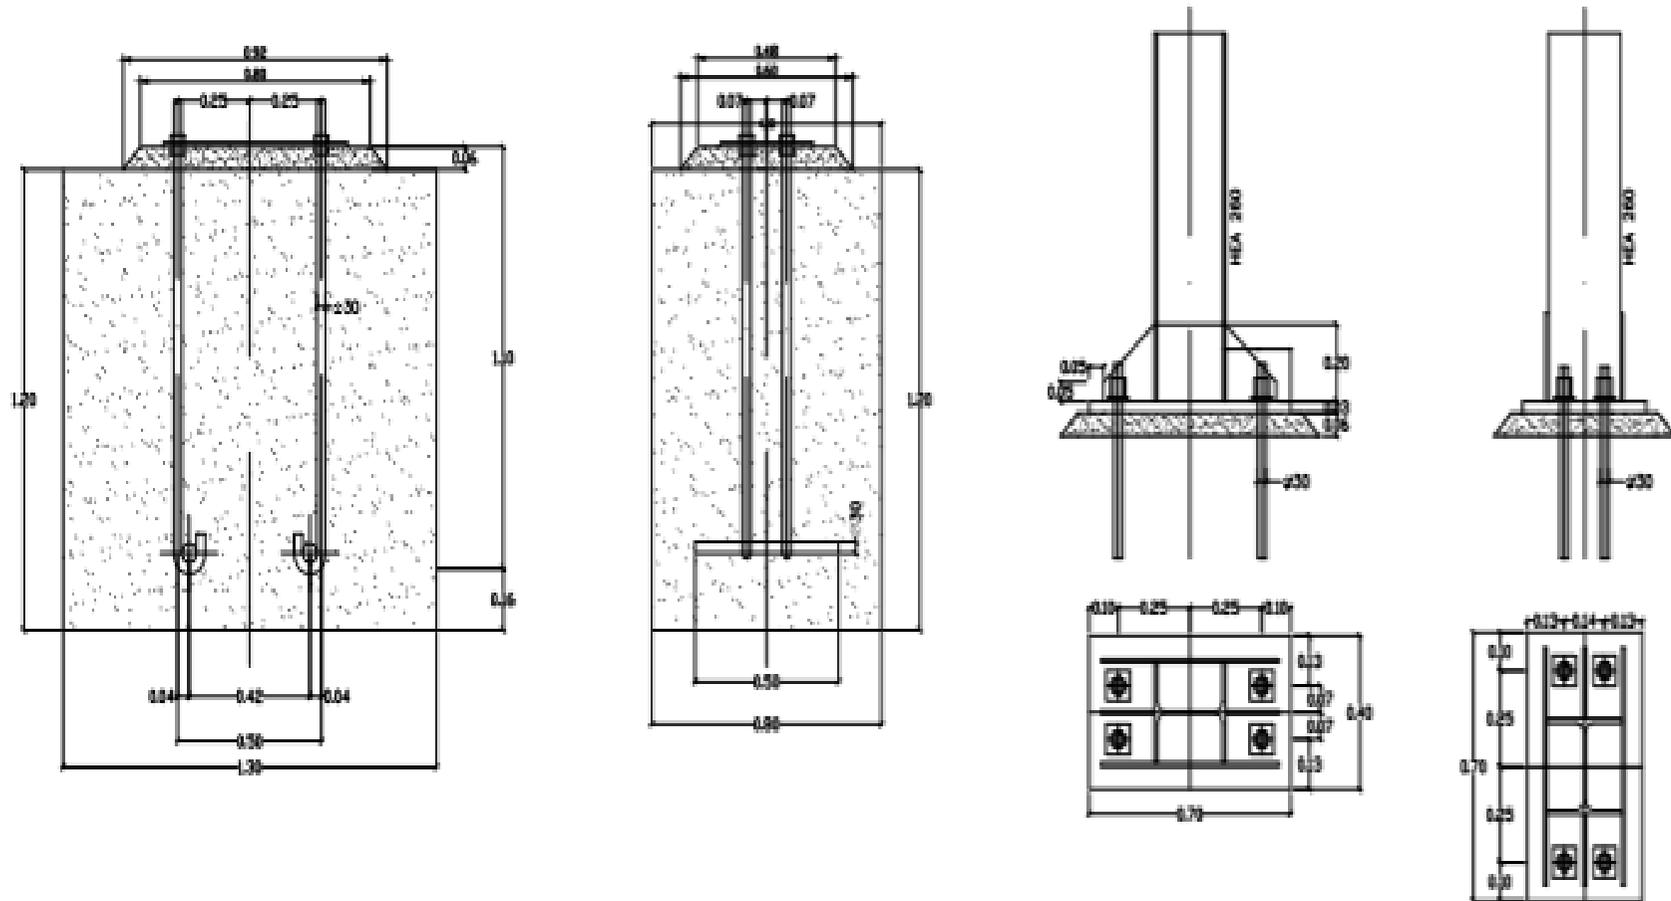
Murillo. (2017) Detalle de anclaje pilar metálico a cimentación de aprisco. Bogotá: Colegio Rural José Celestino Mutis –IED.
